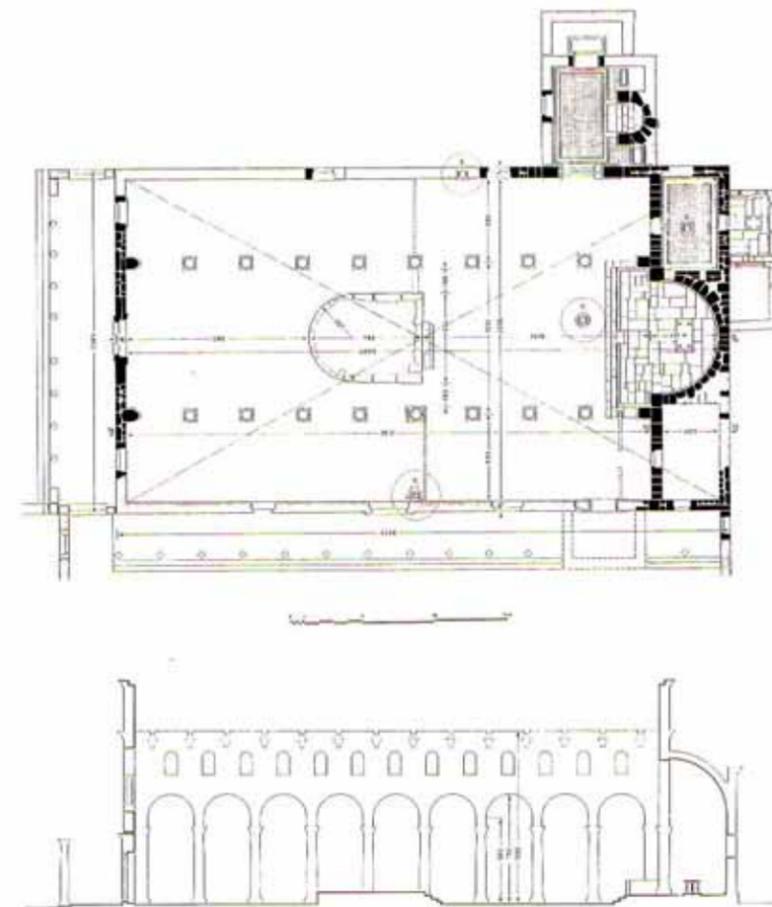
Nordsyrische Bema - Kirche, Grundriss, Schnitt durch die Mittelachse
